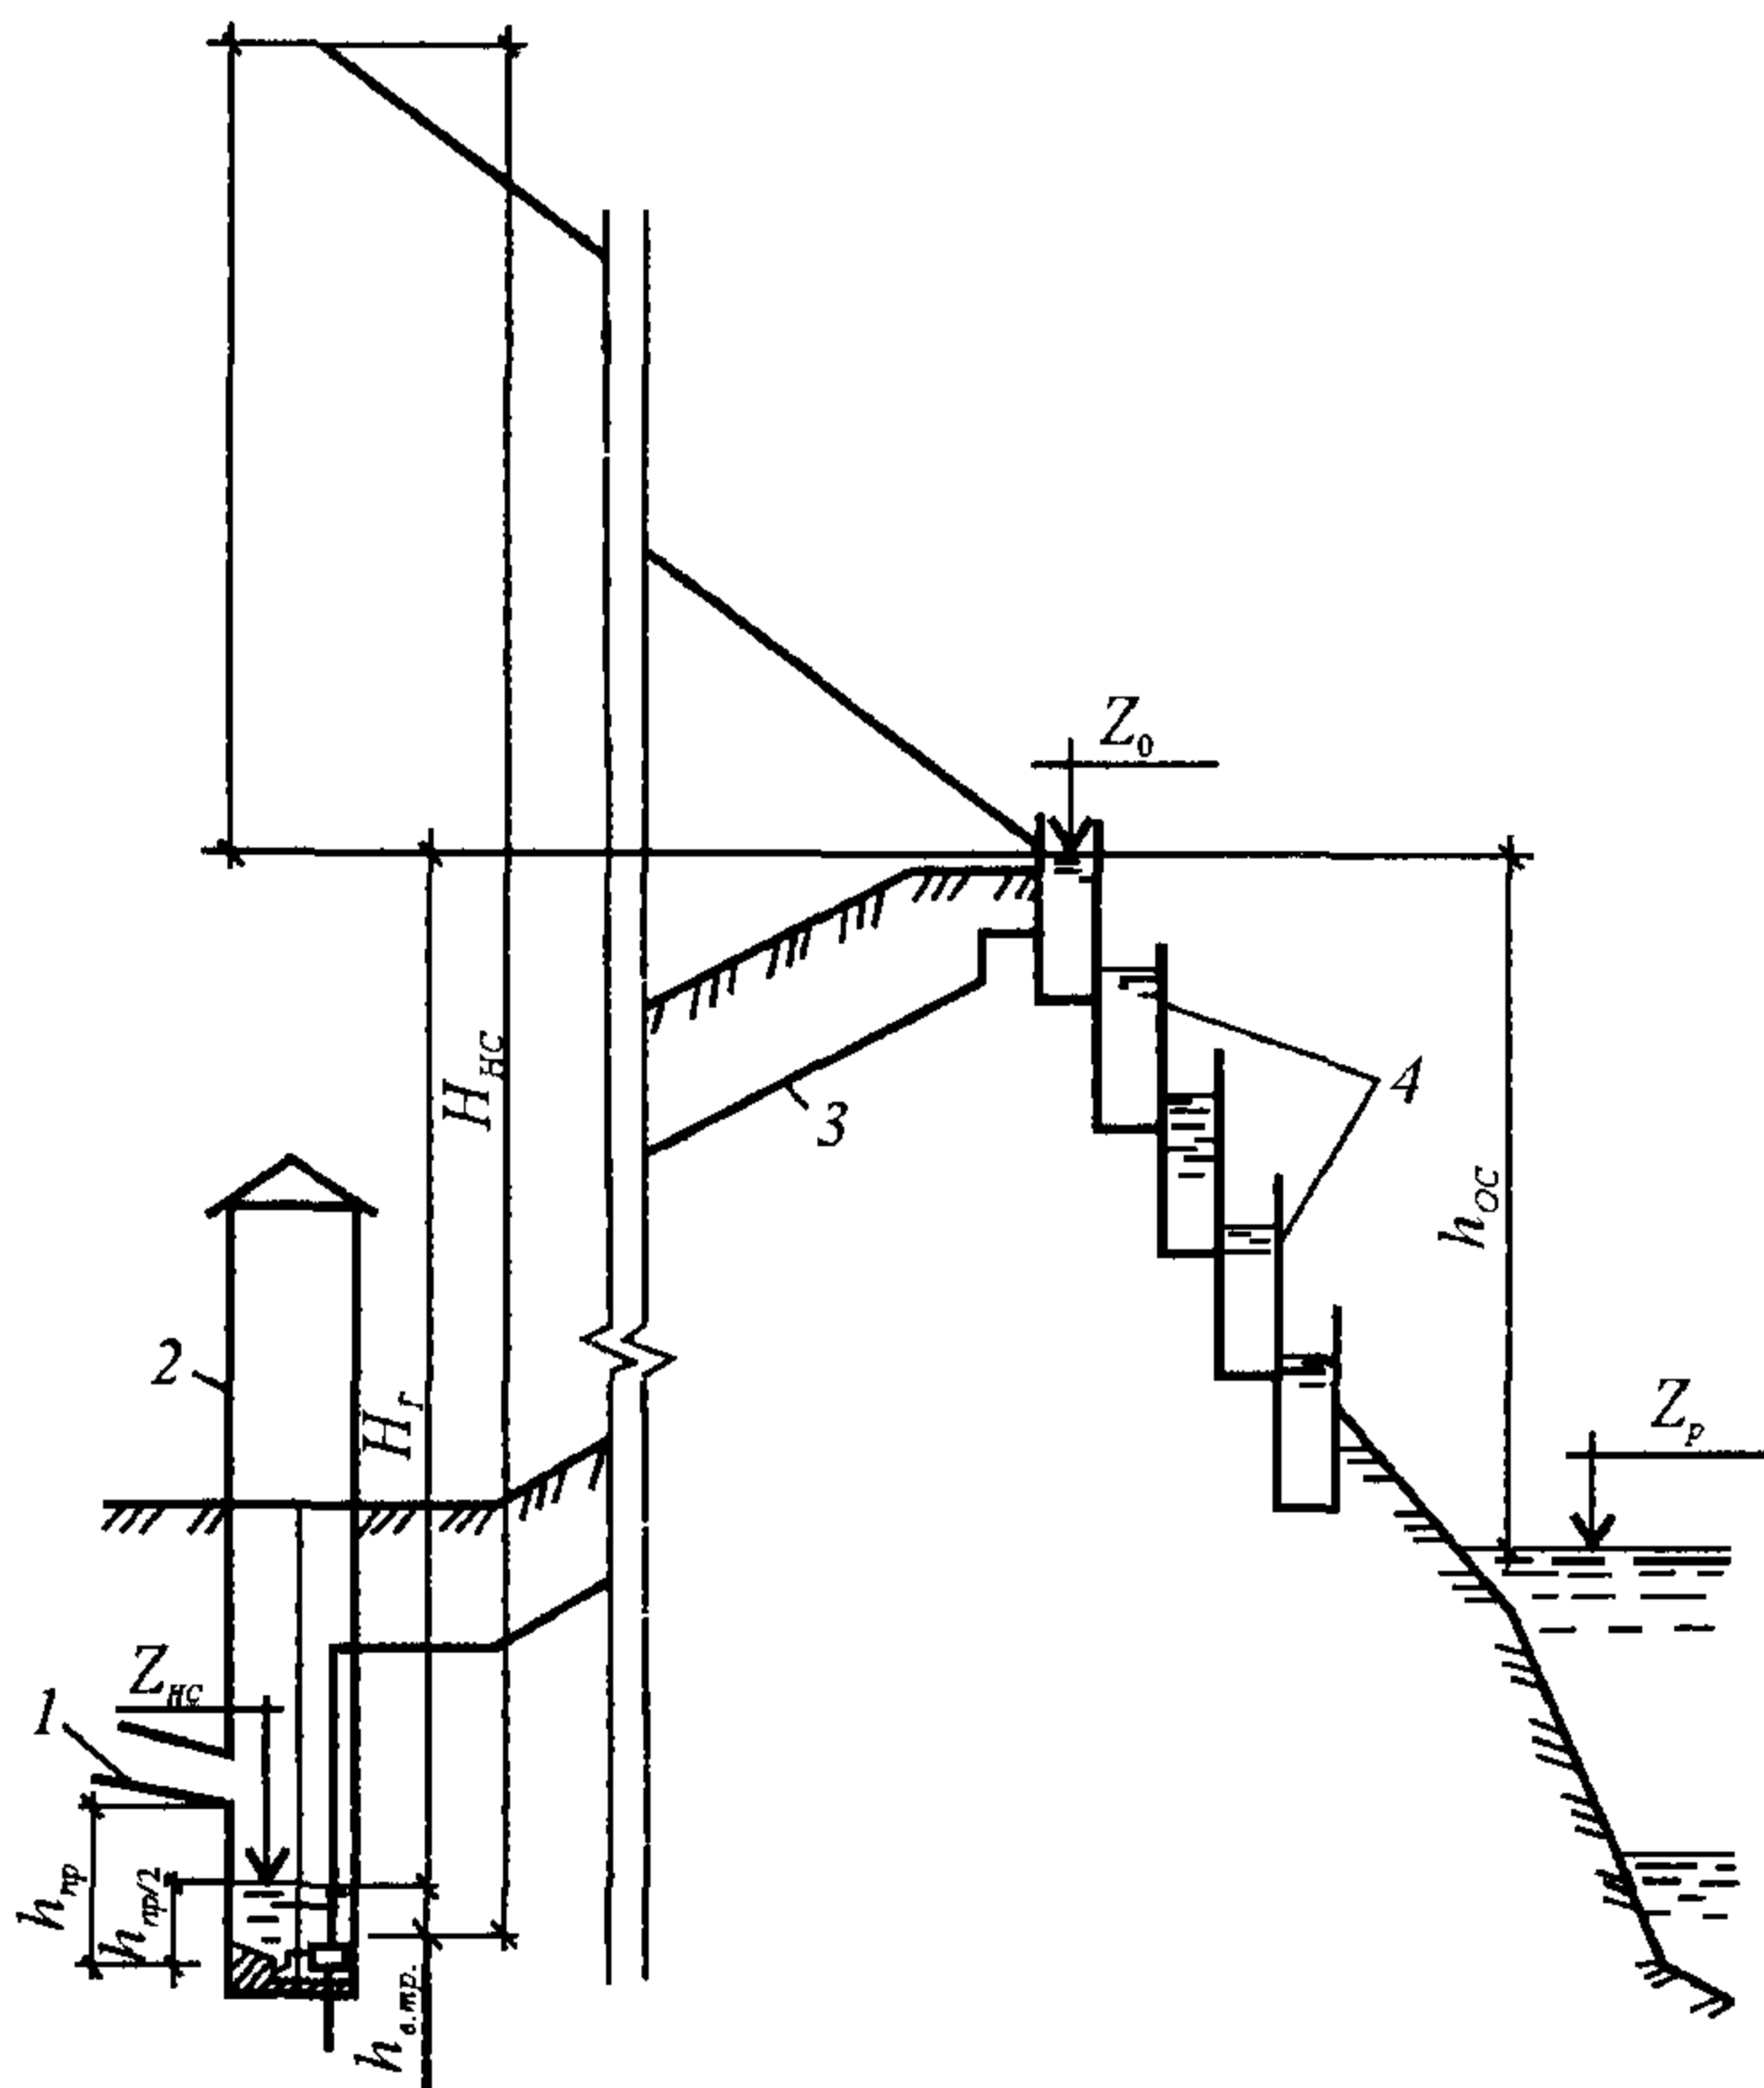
Высотная схема расположения насосной станции и напорного трубопровода:
